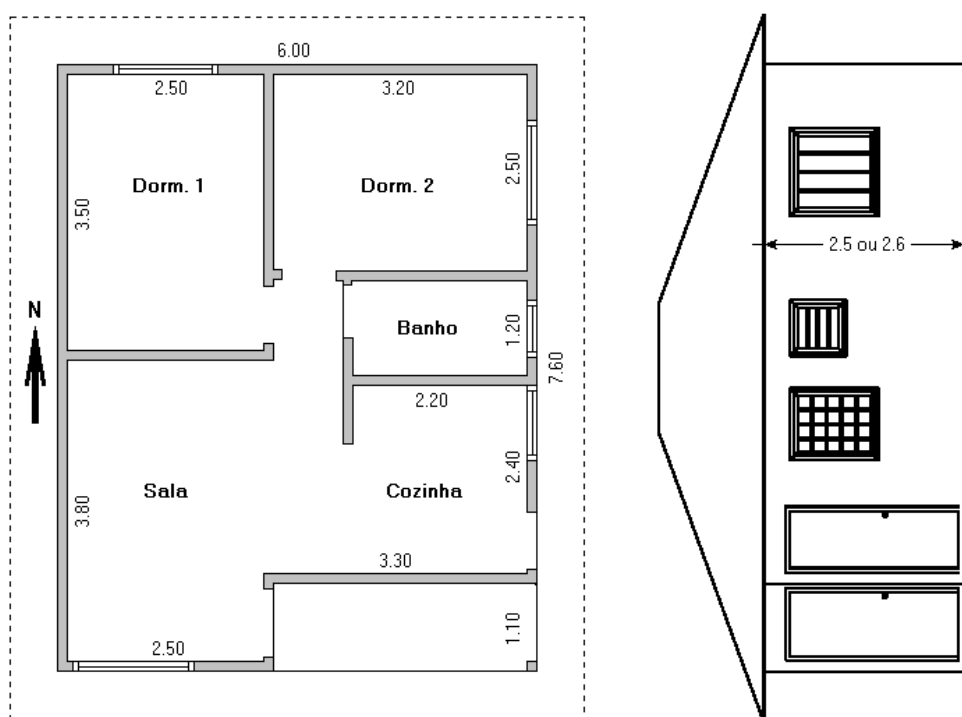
Projeto Padrão de Habitação Térrea Unifamiliar - Planta e Fachada Lateral
